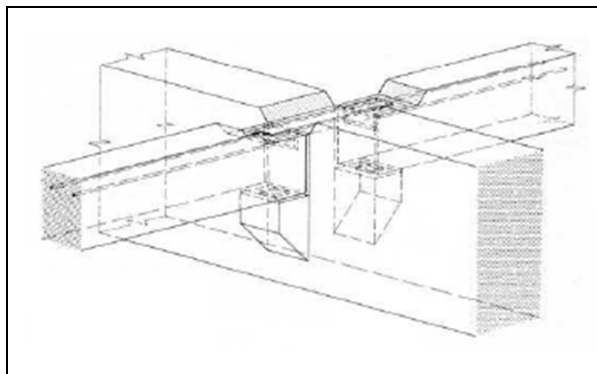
Ligação por consolas curtas e chapas soldadas (Stupré, 1981)
